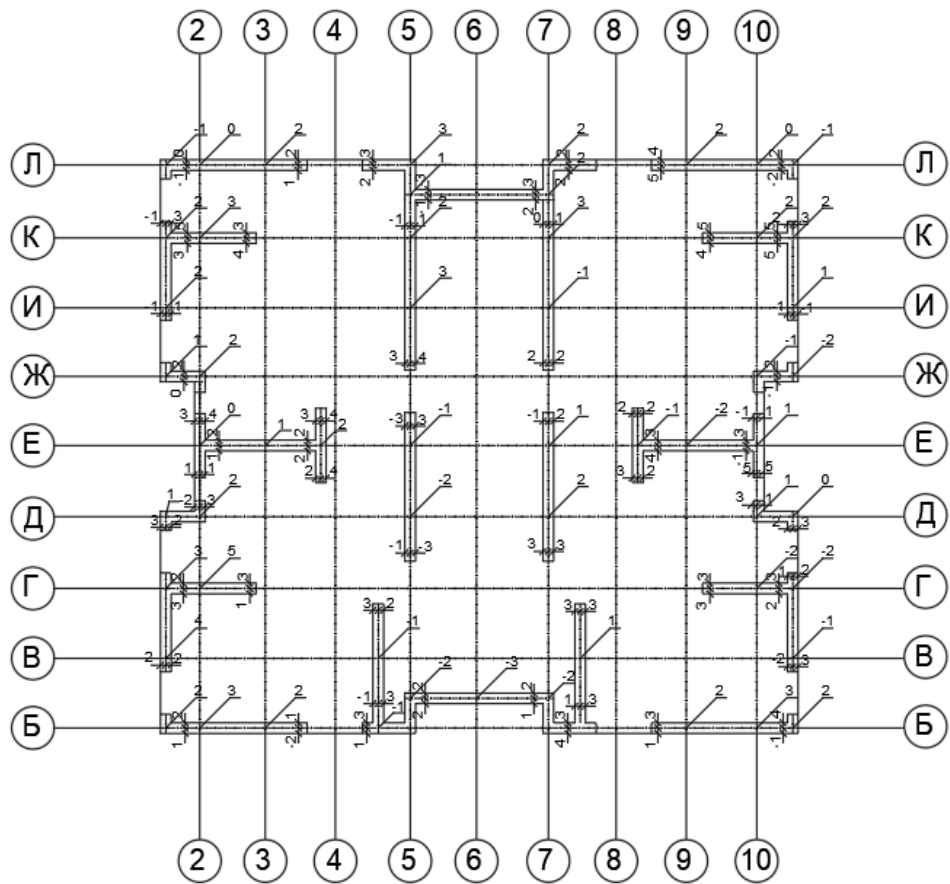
Схема виконавчого знімання стін типового поверху будівлі
